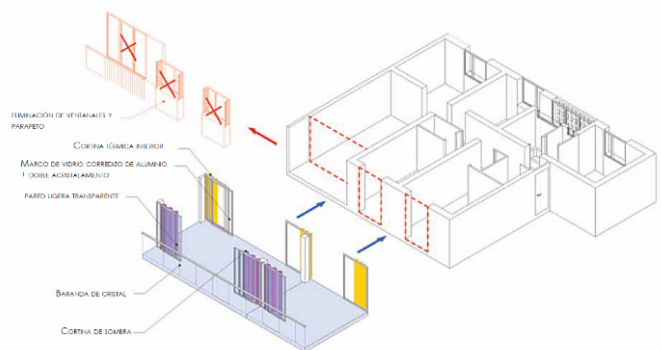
Eliminación de los paneles de la fachada para la colocación de los invernaderos adosados tipo balcón. Fuente: lacatonvassal.com
